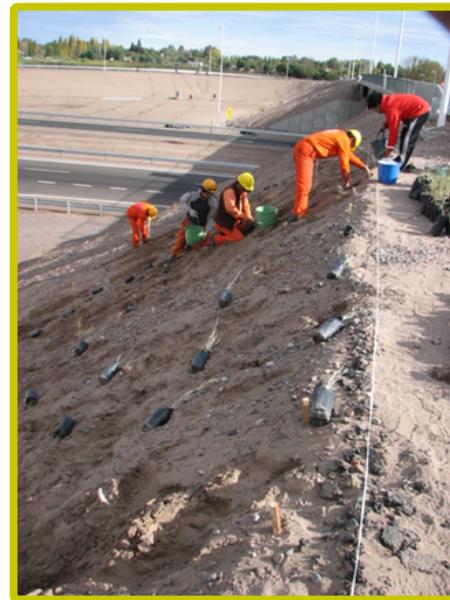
Plantación de tupe y olivillo en parcelas del talud vial transversal a la Ruta Nac. N° 7, en el mes de marzo.
